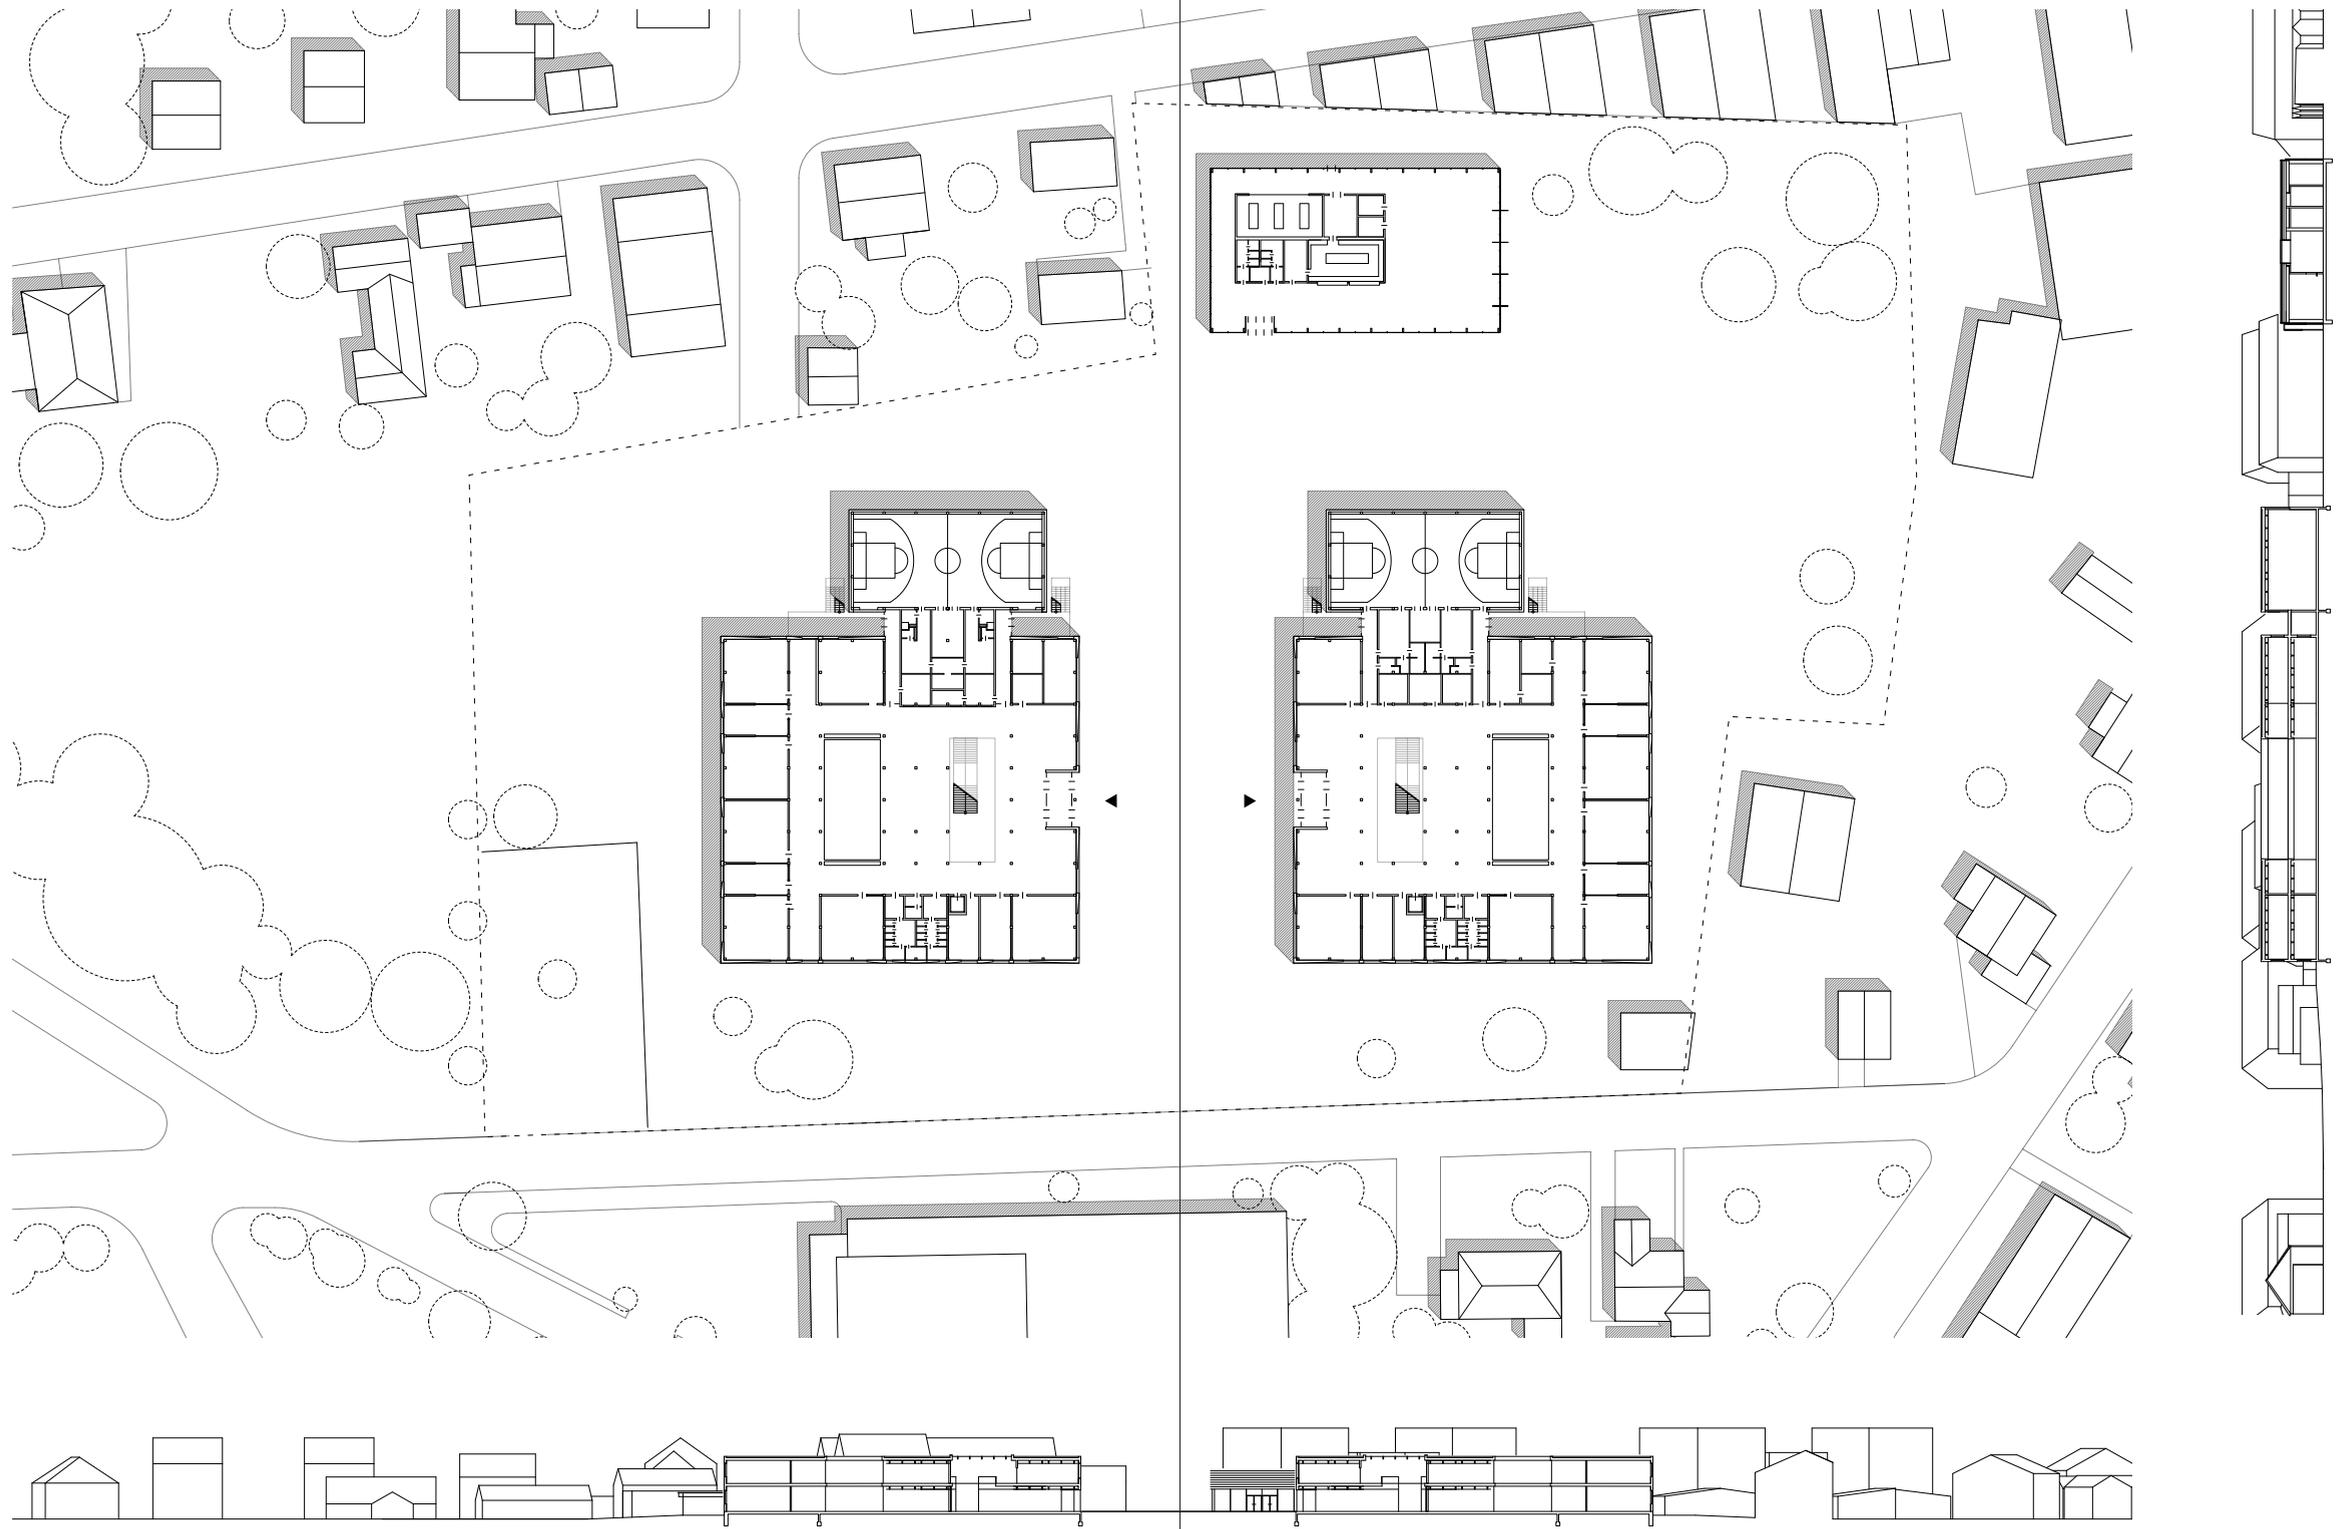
Lageplan mit Erdgeschossgrundriss 1:1000
